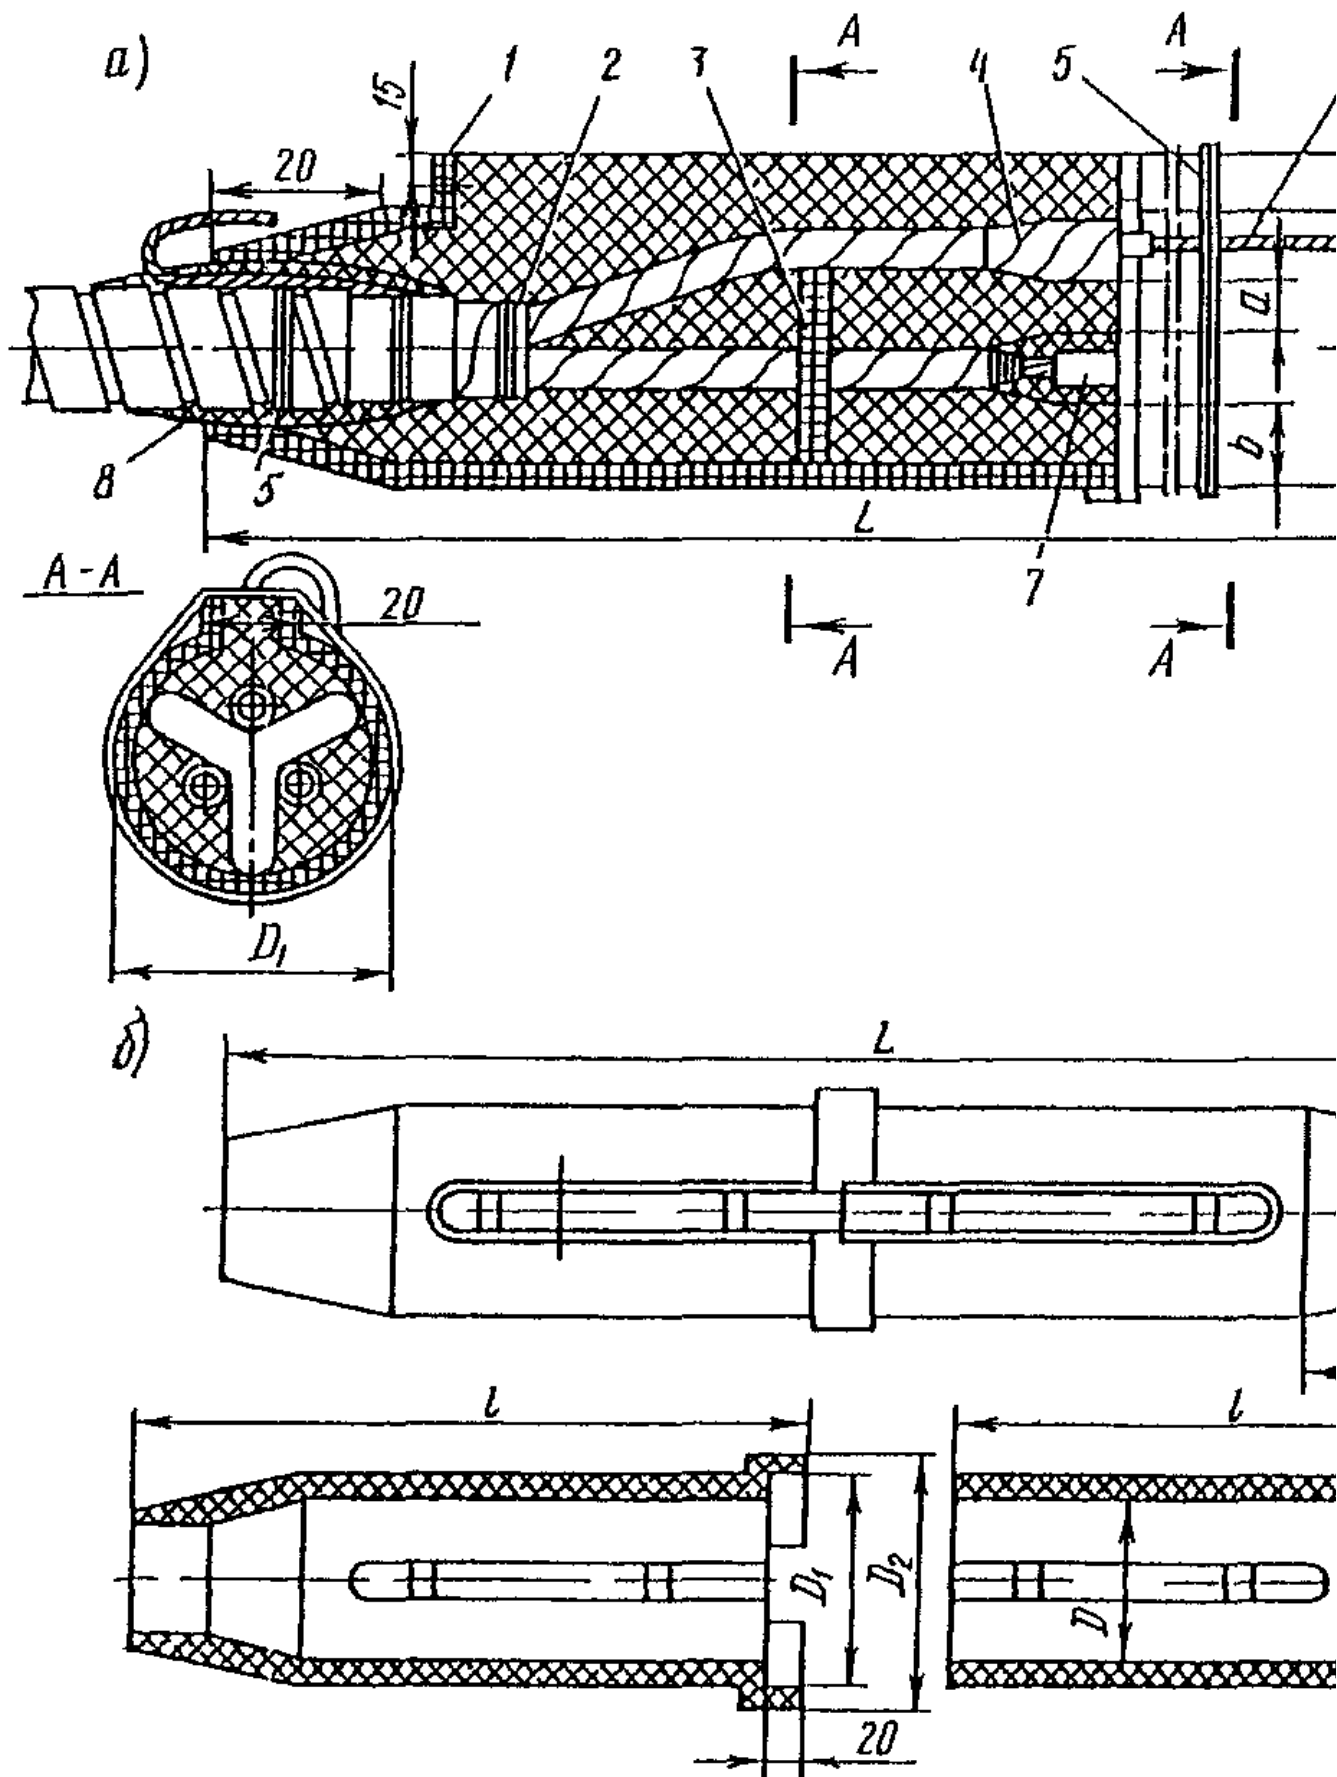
Соединение кабелей в эпоксидной муфте типа СЭп: а - муфта; б - корпус; 1 - корпус муфты; 2 - бандаж из суровых ниток; 3 - распорка; 4 - подмотка жилы; 5 - проволочный бандаж; 6 - провод заземления; 7 - соединение жил; 8 - герметизирующая подмотка
